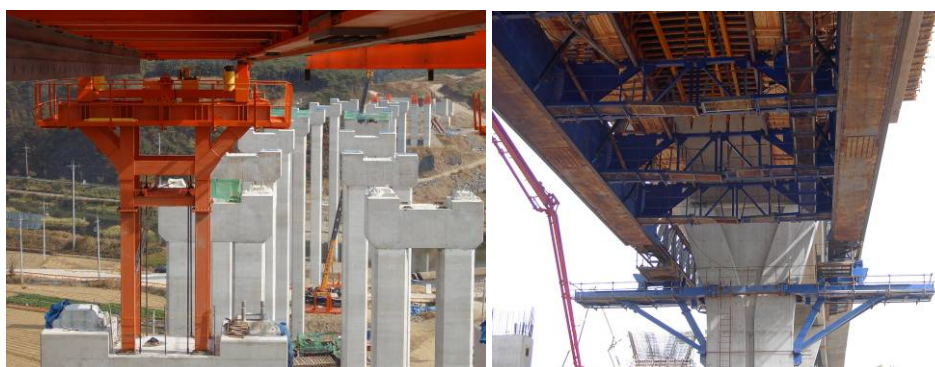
e 5 – Apoio de cimbra superior(esq) e inferior(dir) em pilares com capitel
